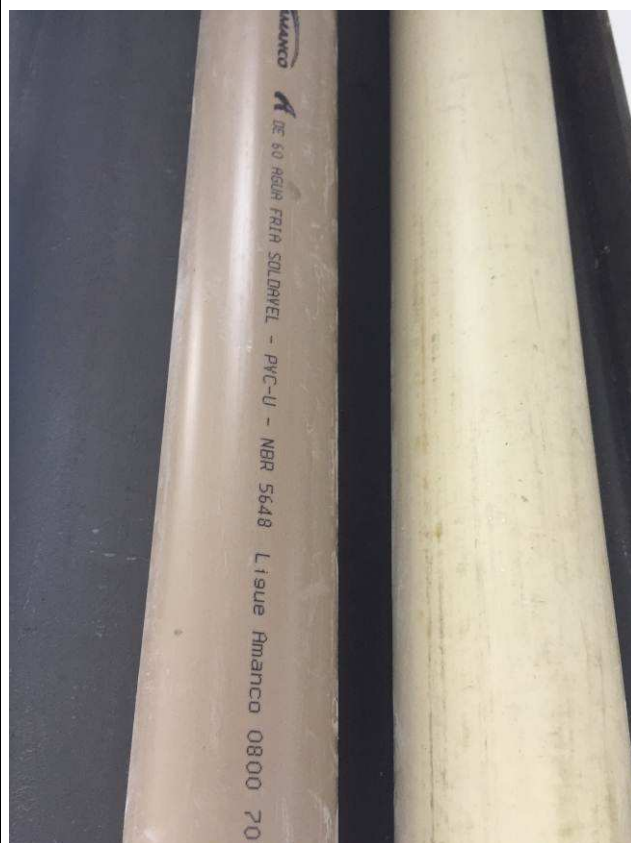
C: Tubulação de condução dos dejetos (Ø 60 mm), e tubulação de ventilação (Ø 75 mm) da estação elevatória de esgoto.
